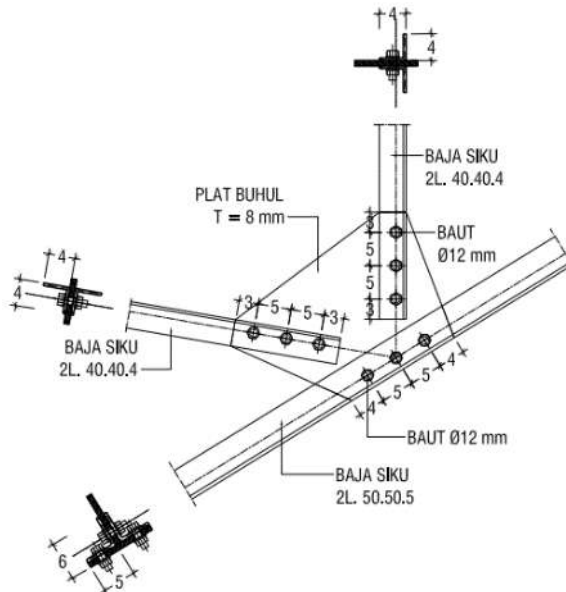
Contoh gambar kuda-kuda baja rangka truss
